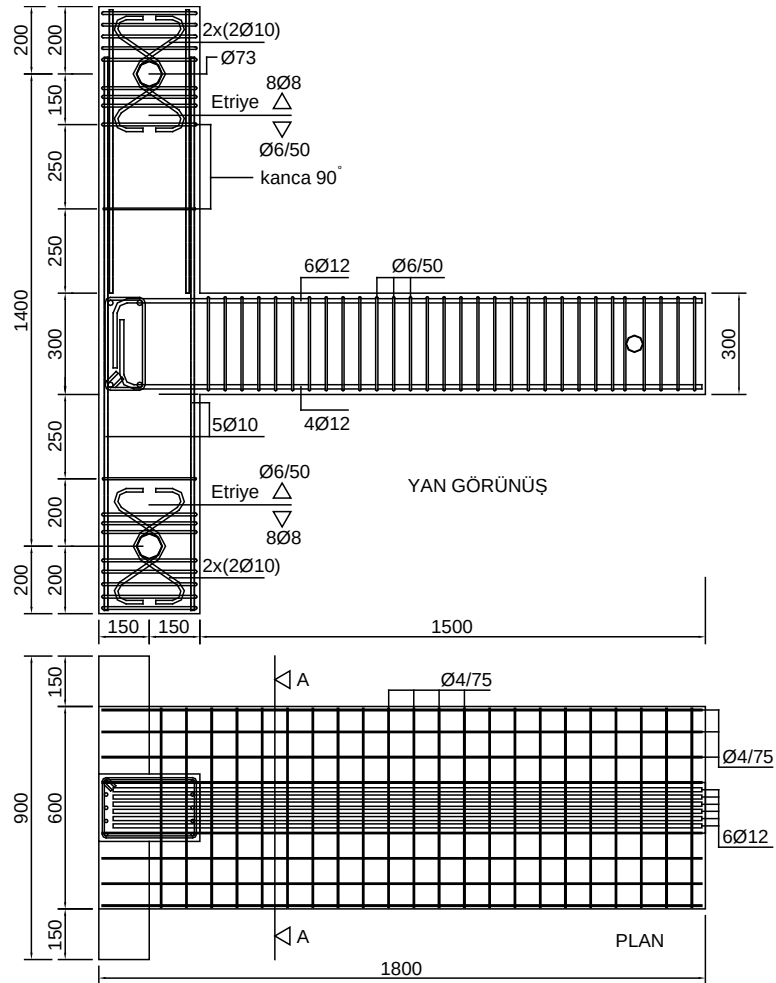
WC1c elemanı donatı detay çizimleri
